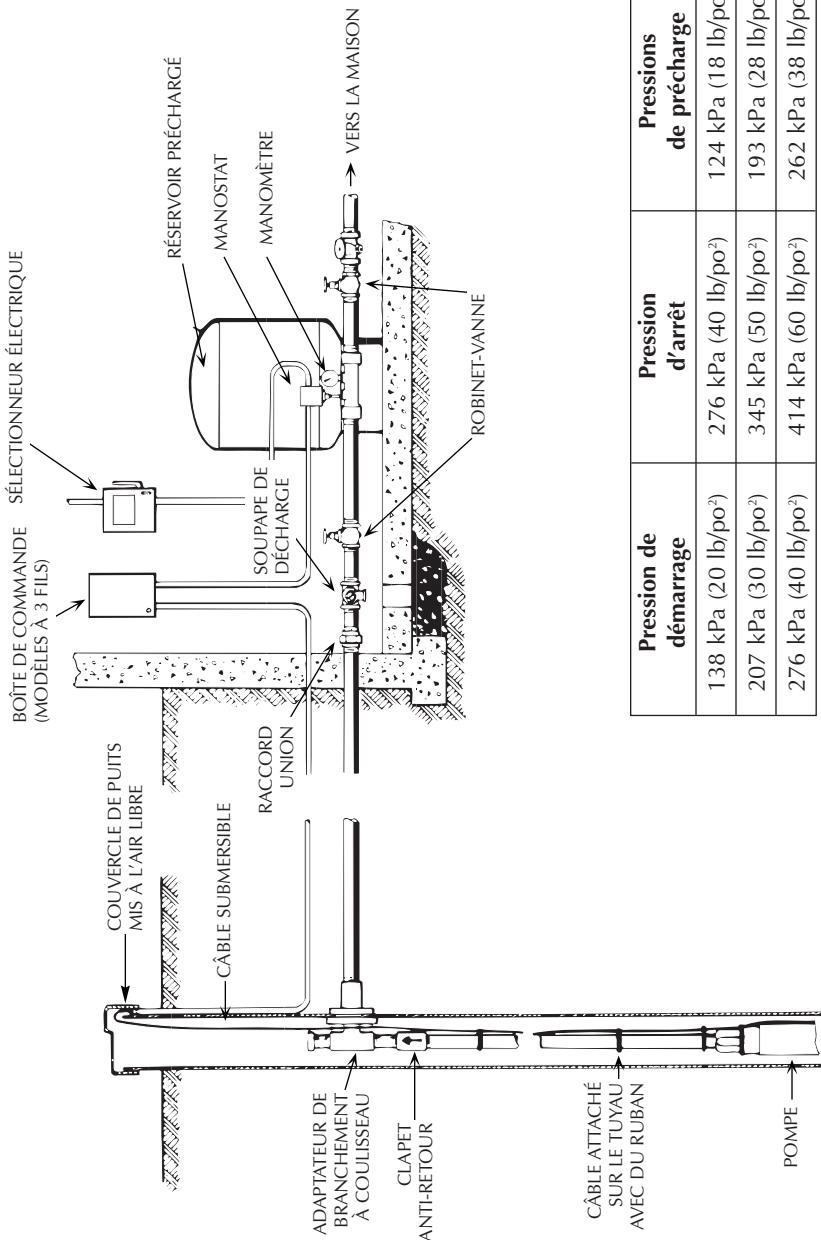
Installation type d'une pompe submersible branchée sur un réservoir préchargé
